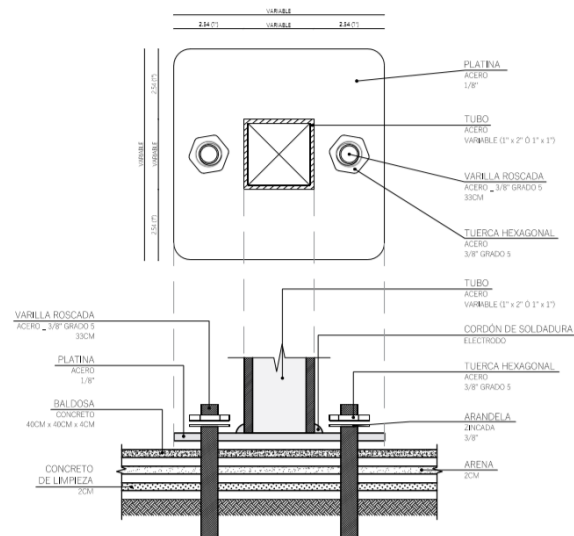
Plano detalle del anclaje con chazos metálicos.
